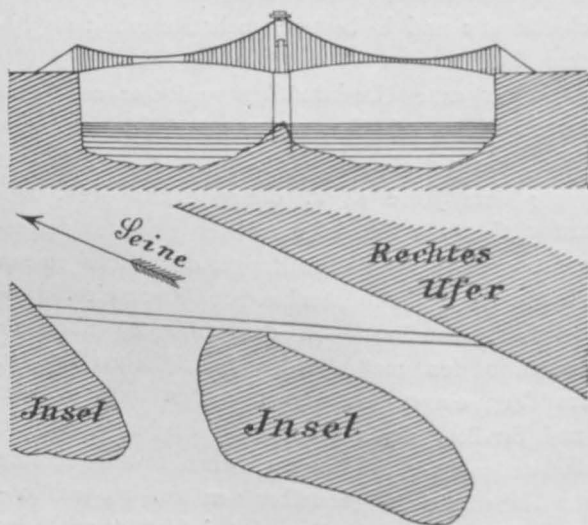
Lageplan der Louis Philipp-Brücke über die Seine in Paris. 1833.
